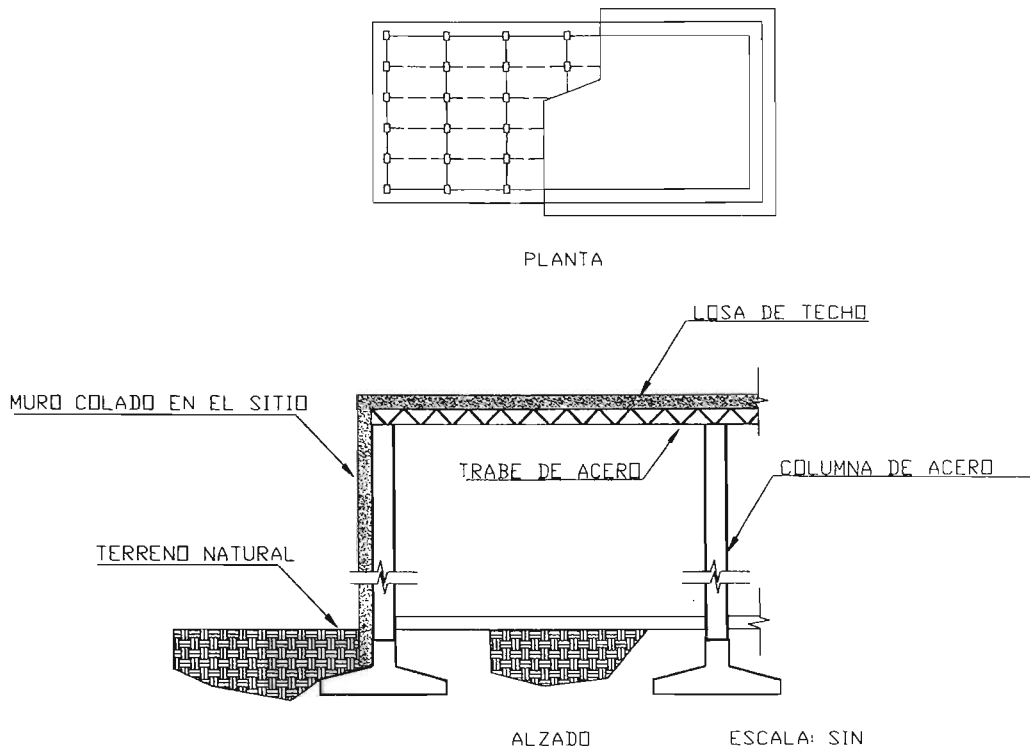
Estructura de muros de concreto colados en el sitio.
